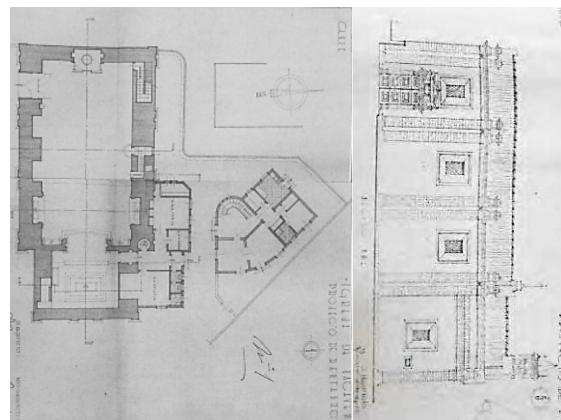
Alçado principal e planta da igreja, após o restauro, s/esc., 1951
